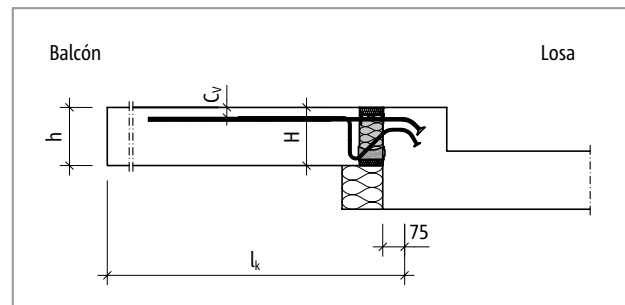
Schöck Isokorb® T tipo K-O: Sistema estático
